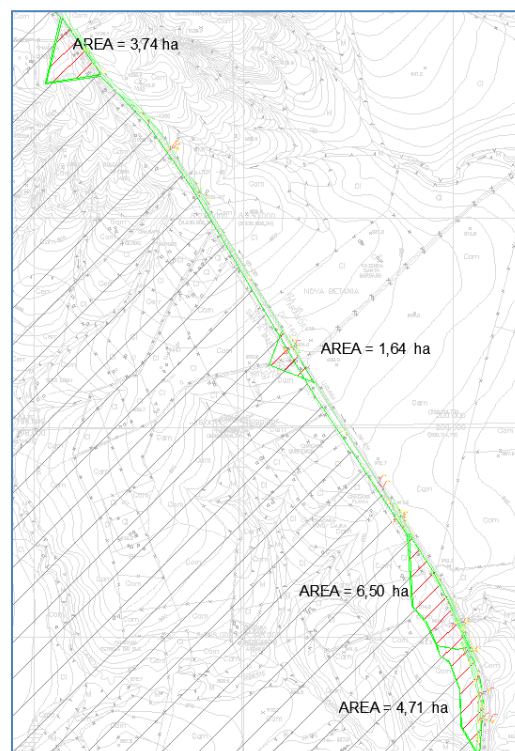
Levantamento de Bacias – Detalhes 02
